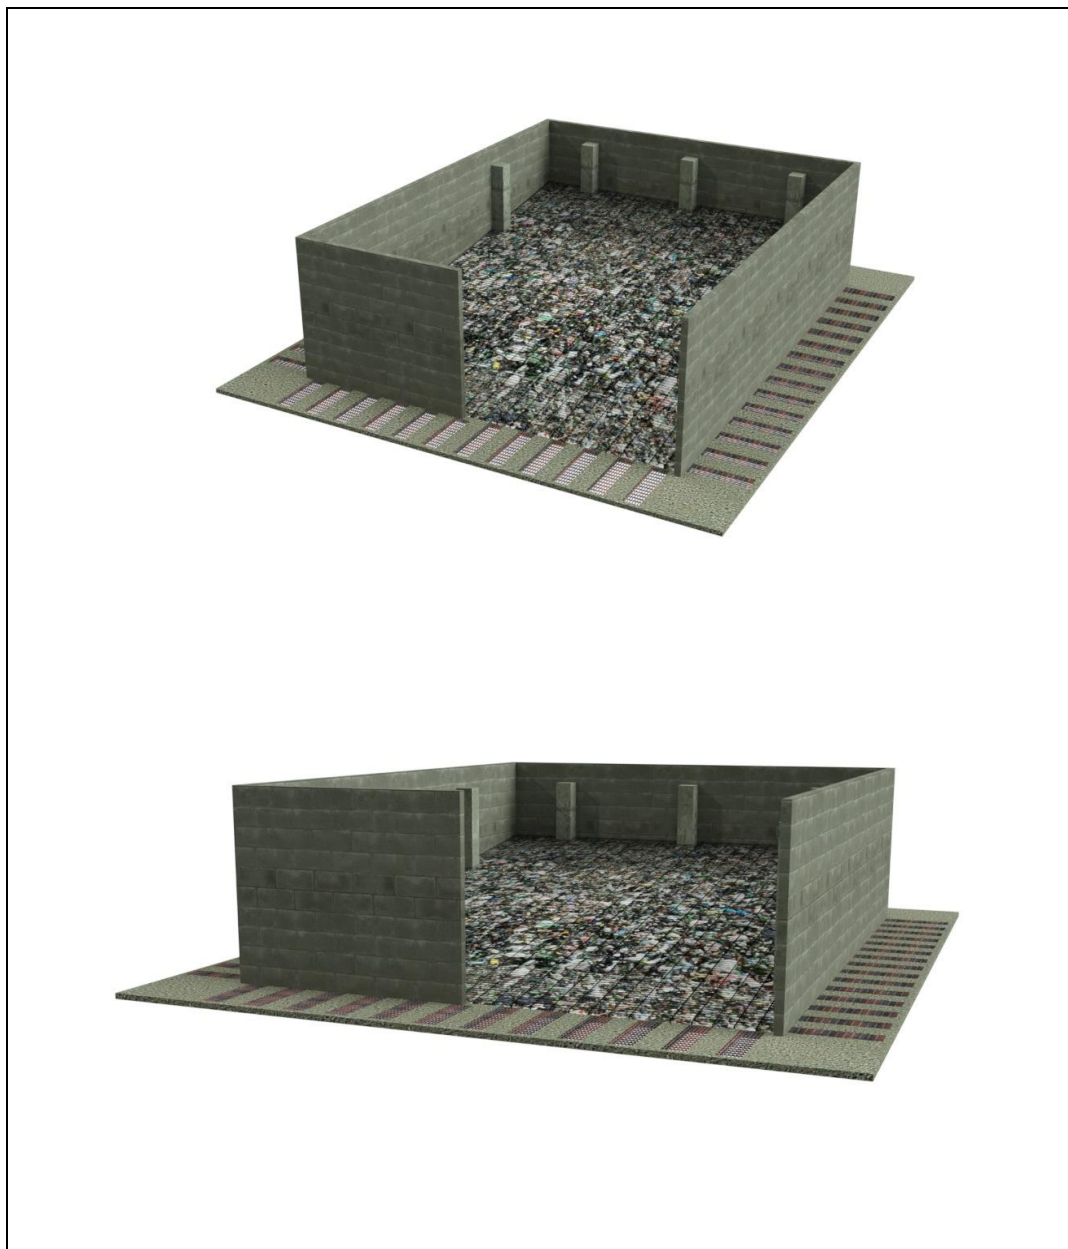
Diseño reestructuración "patio de basura".* Fuente: elaboración propia con AutoCAD.
